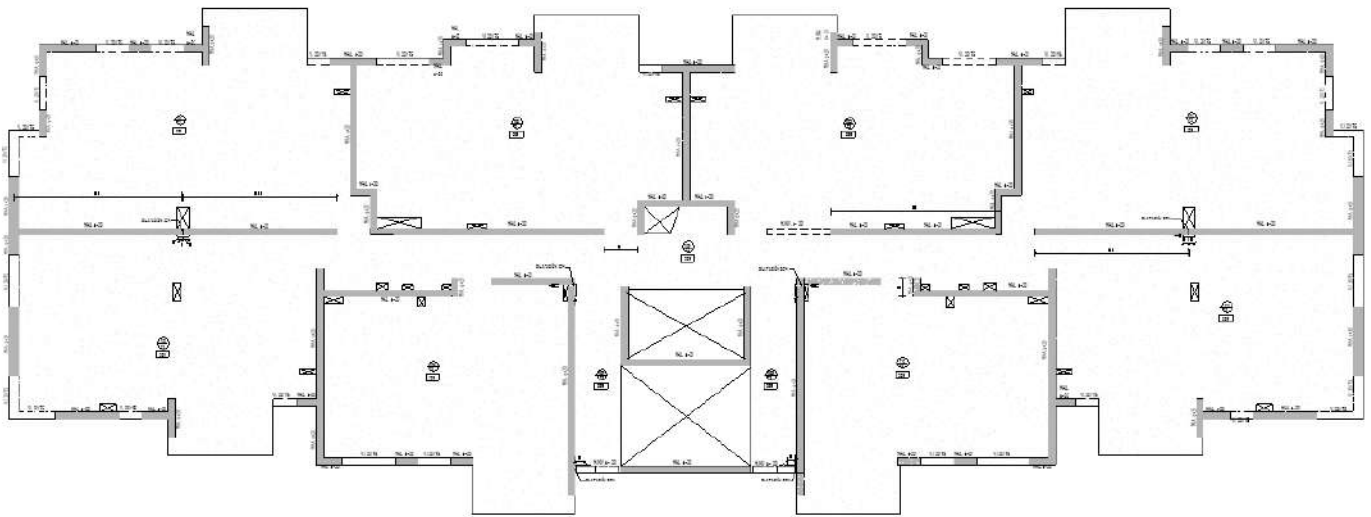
Planta estructural del edificio Parque Peñablanca, cortesía de Carvallo Ingeniería cálculo estructural.
